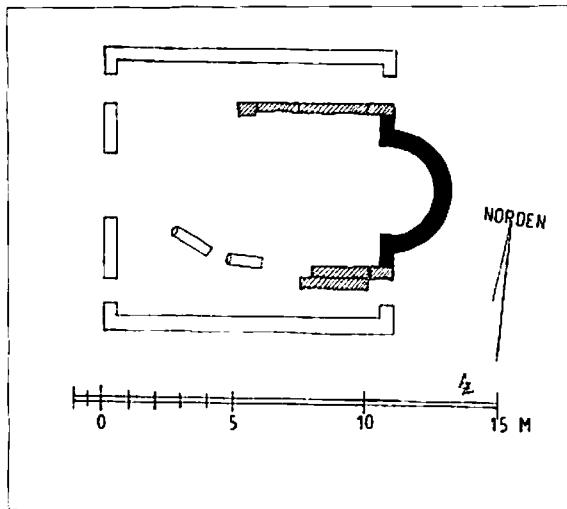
Chiesa paleocristiana, planimetria / Frühchristliche Kirche, Grundriß.
